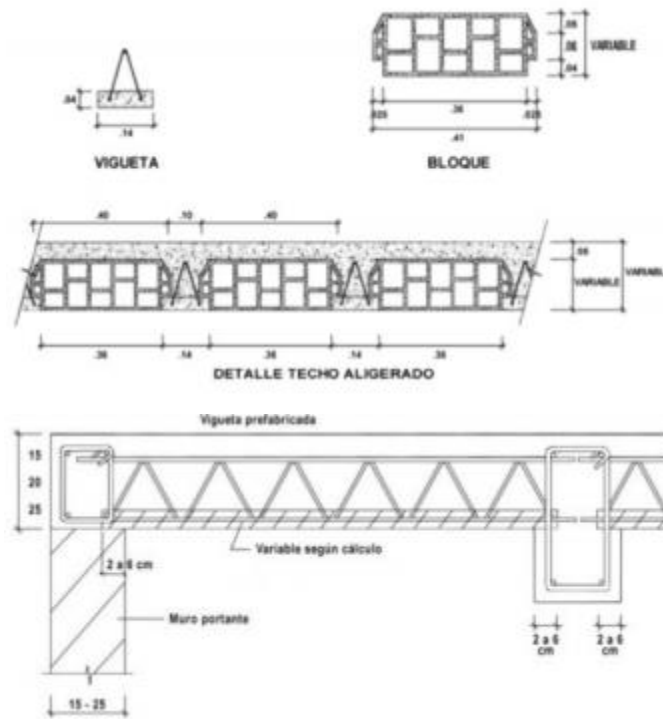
Diseño estructural de las viguetas pre fabricadas
